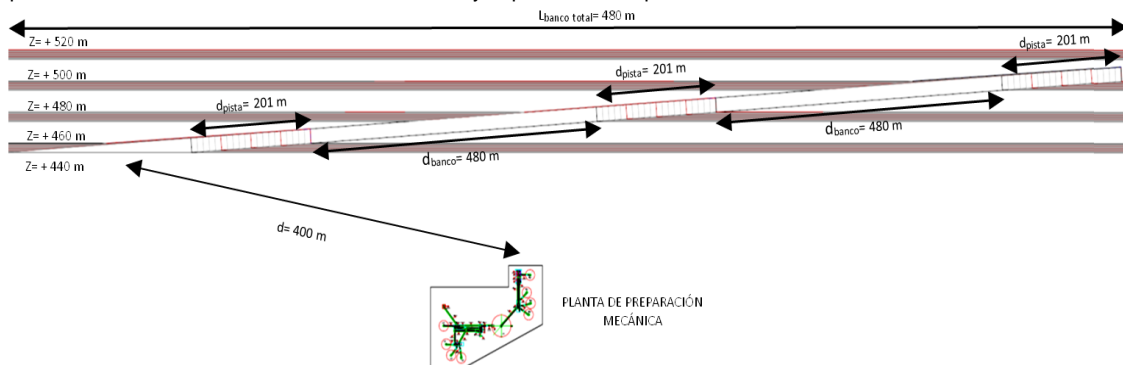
Representación en planta de los bancos de trabajo y de la planta de preparación mecánica.
